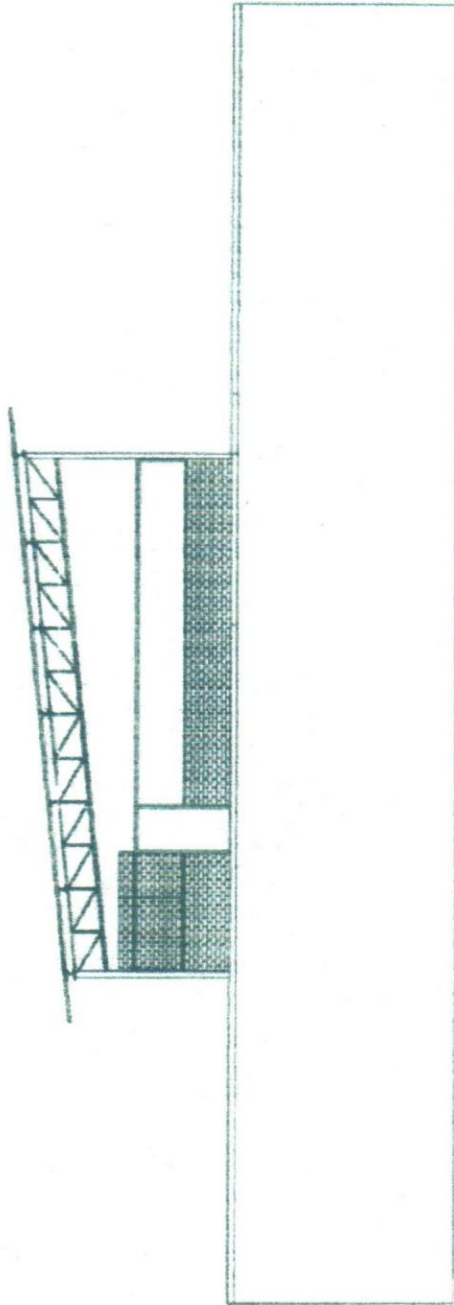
Vivero U.C.A.B.; plano de estructura – fachada lateral Este.
